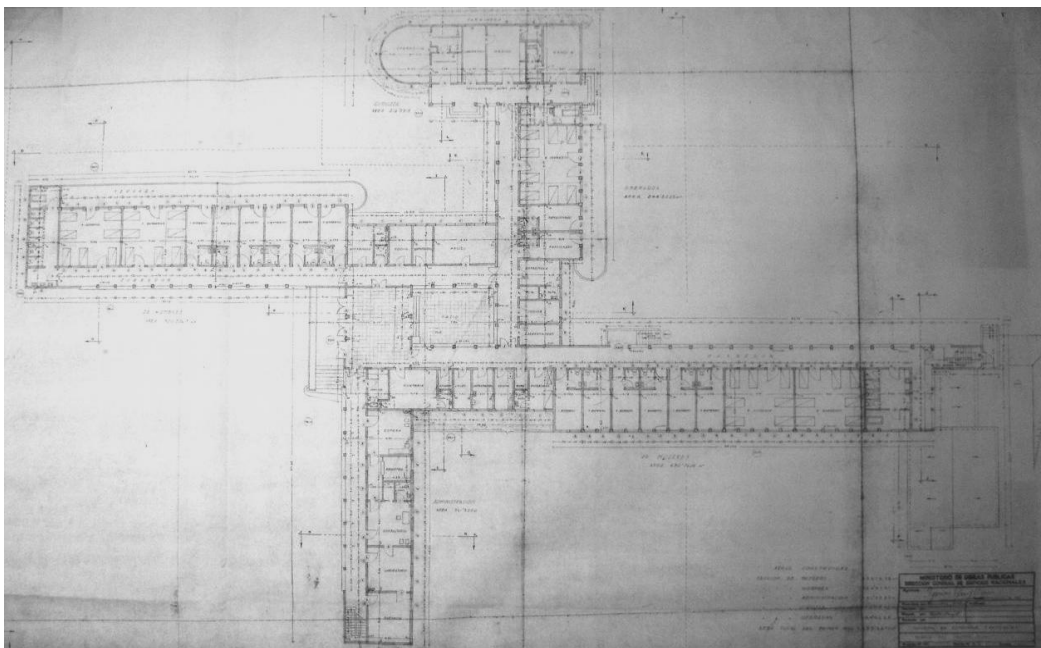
Zweites Projekt des Krankenhauses von Concordia. Grundriss des Obergeschosses.
